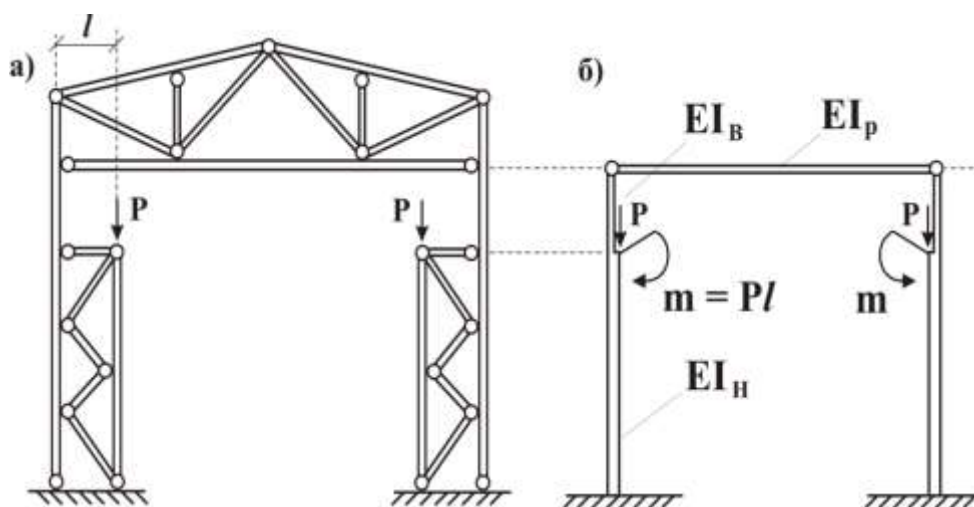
Варианты расчетных схем поперечной рамы каркаса здания.
